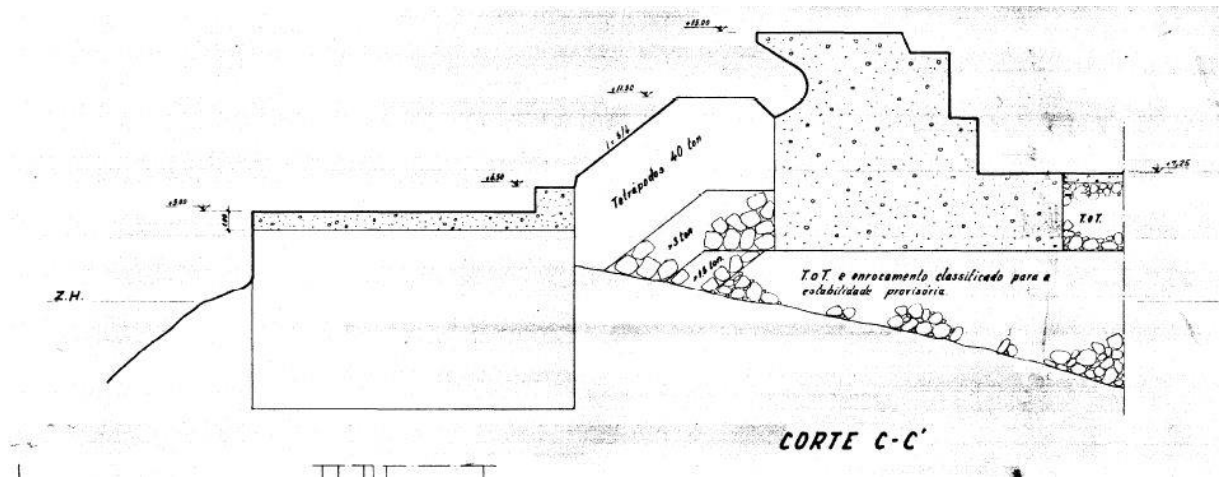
Figura D – Perfil transversal da cabeça do quebramar Norte (APDL, 1973).
